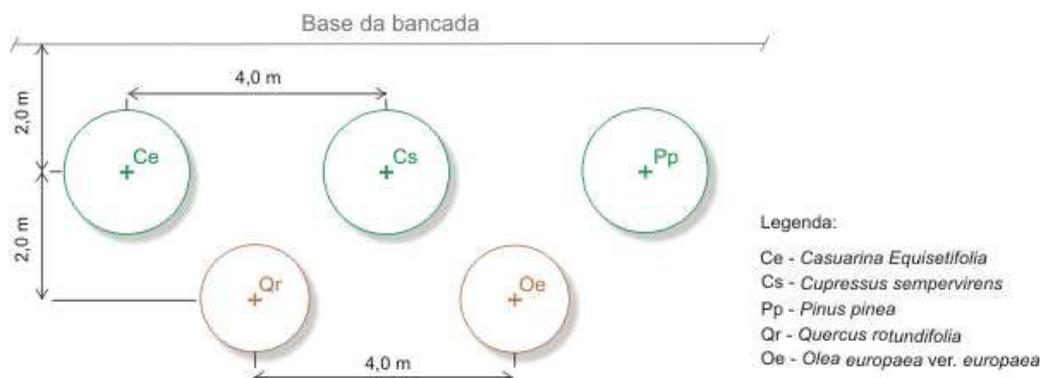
ESQUEMA DE PLANTAÇÃO ARBÓREO (S/ ESCALA).
